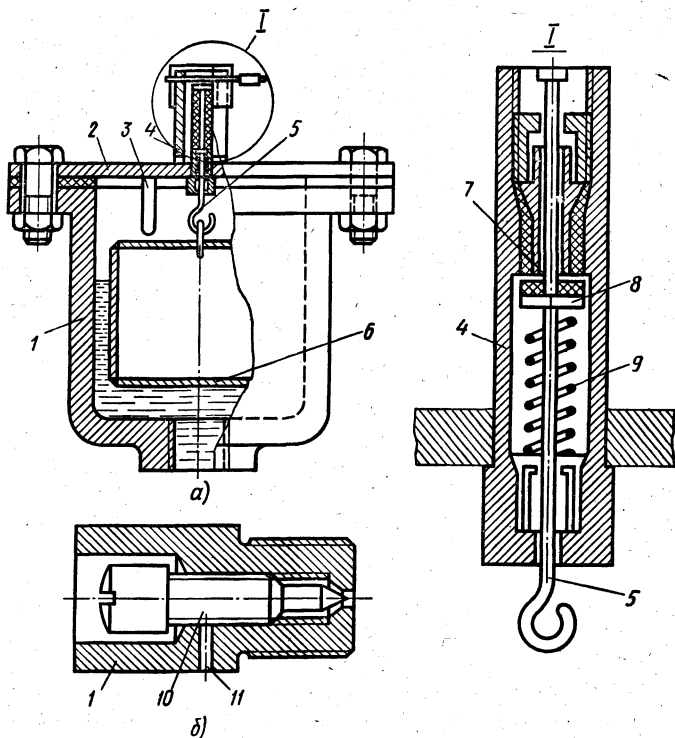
Автоматический воздухоотводчик (а) и воздушный кран (б): 1 — корпус, 2 — крышка, 3 — упор, 4 — клапан-затвор, 5 — тяга, 6 — поплавок, 7 — седло, 8 — клапан, 9 — пружина, 10 — шпindel, 11 — отверстие
